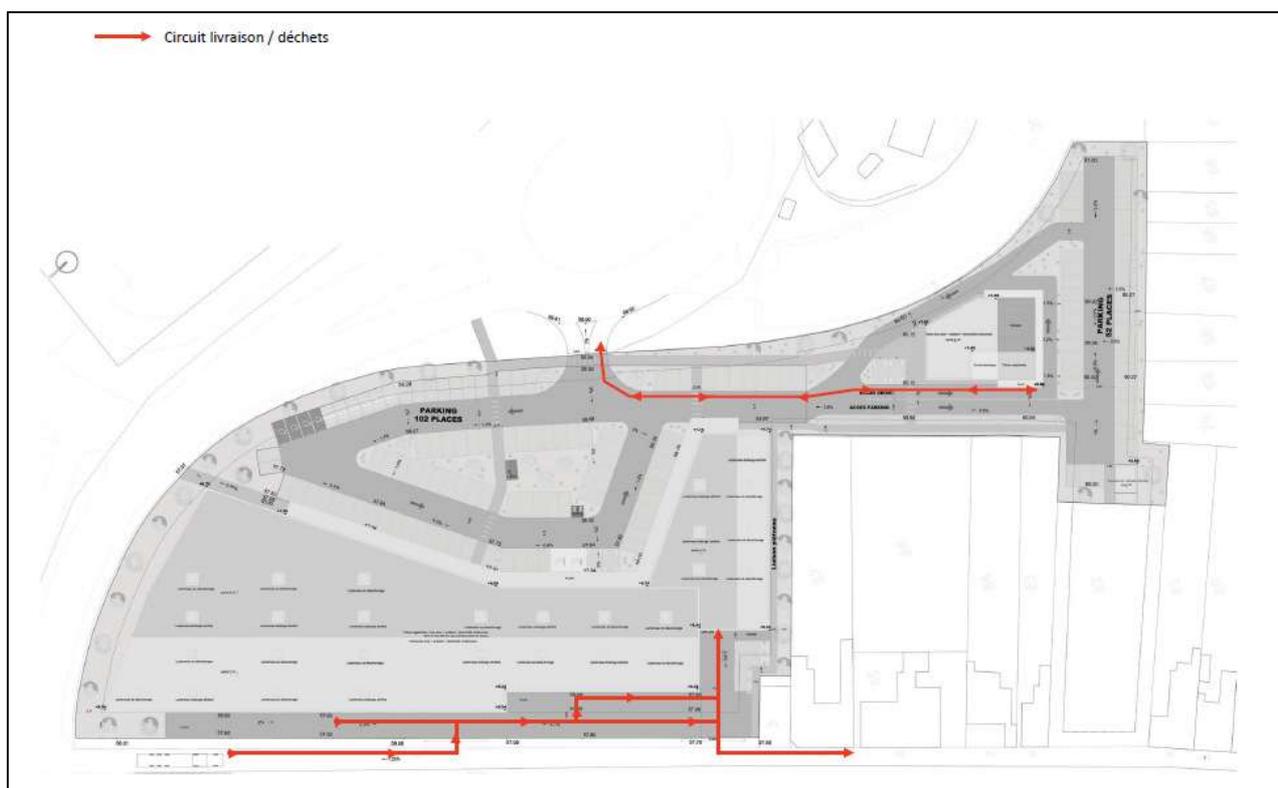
Plan de circulation logistique (source : AVENTIM)
